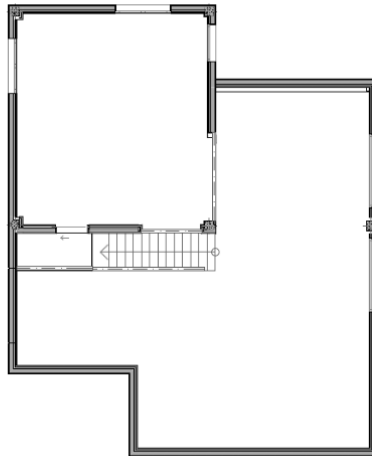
Planta Cambra. Fuente propia. Archicad 20. 2018
